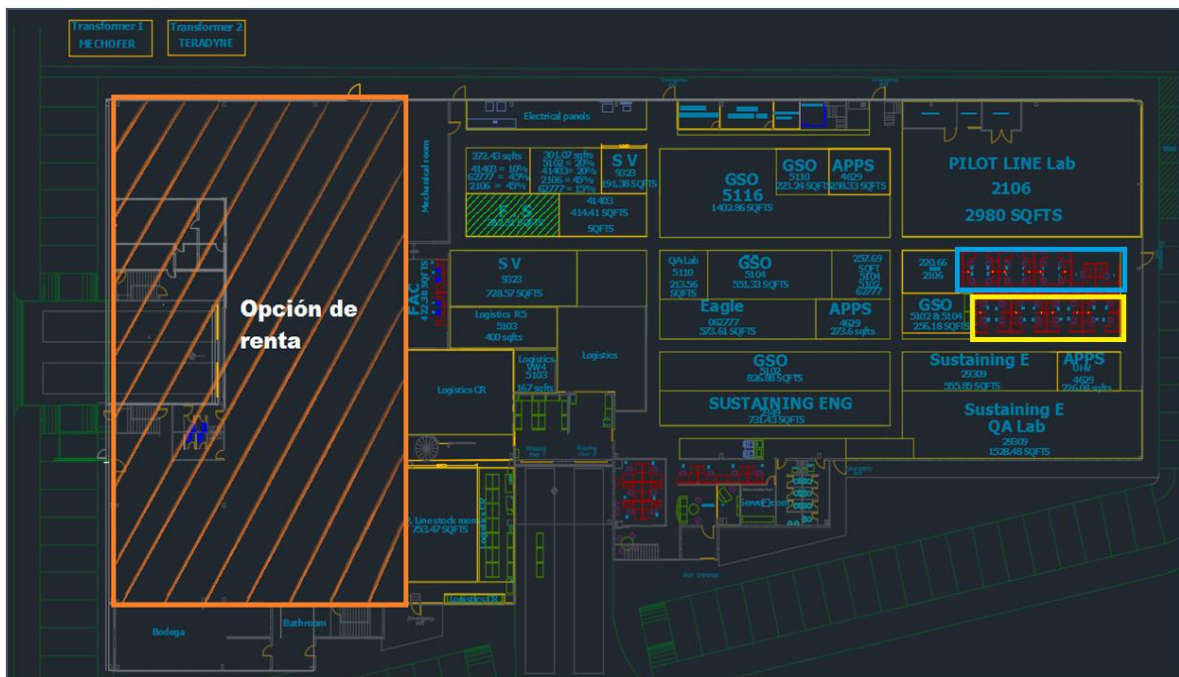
Ubicación actual de cubículos de planta en el edificio D-18.
